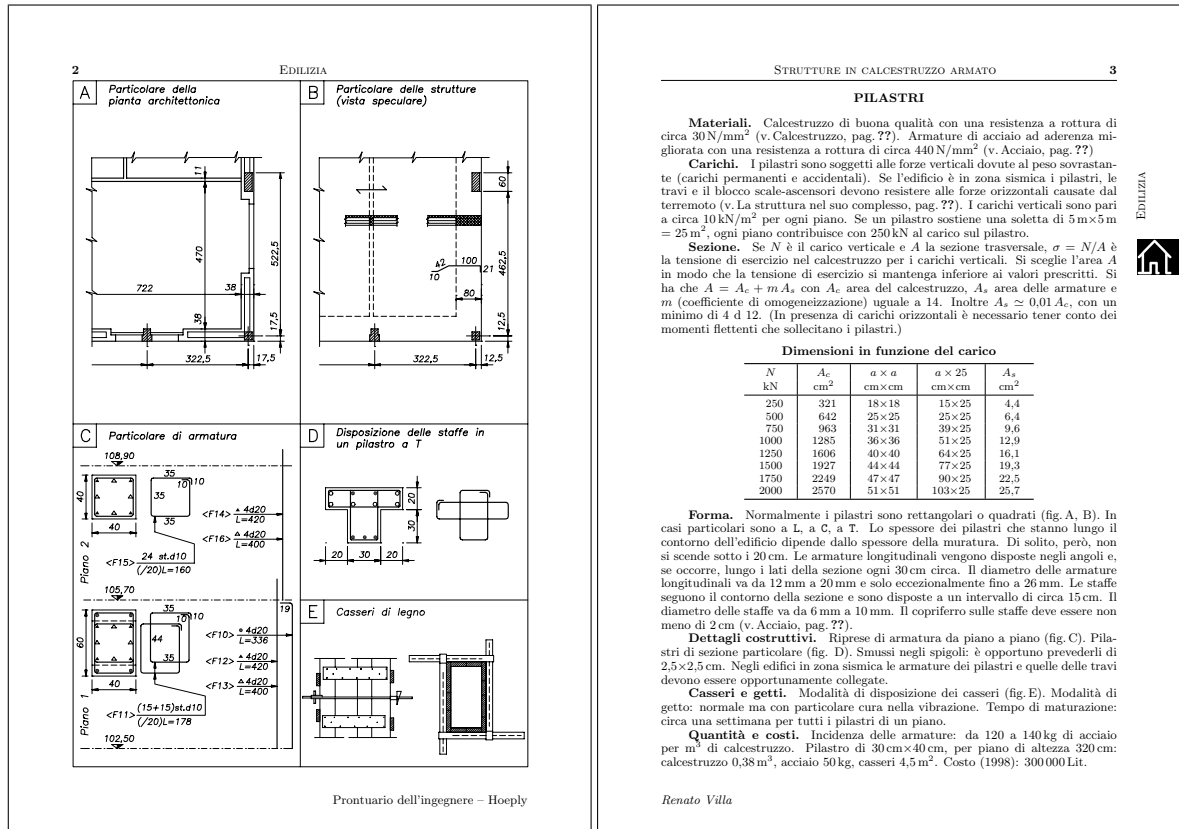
Versione cartacea: il verso e il recto di due pagine successive
